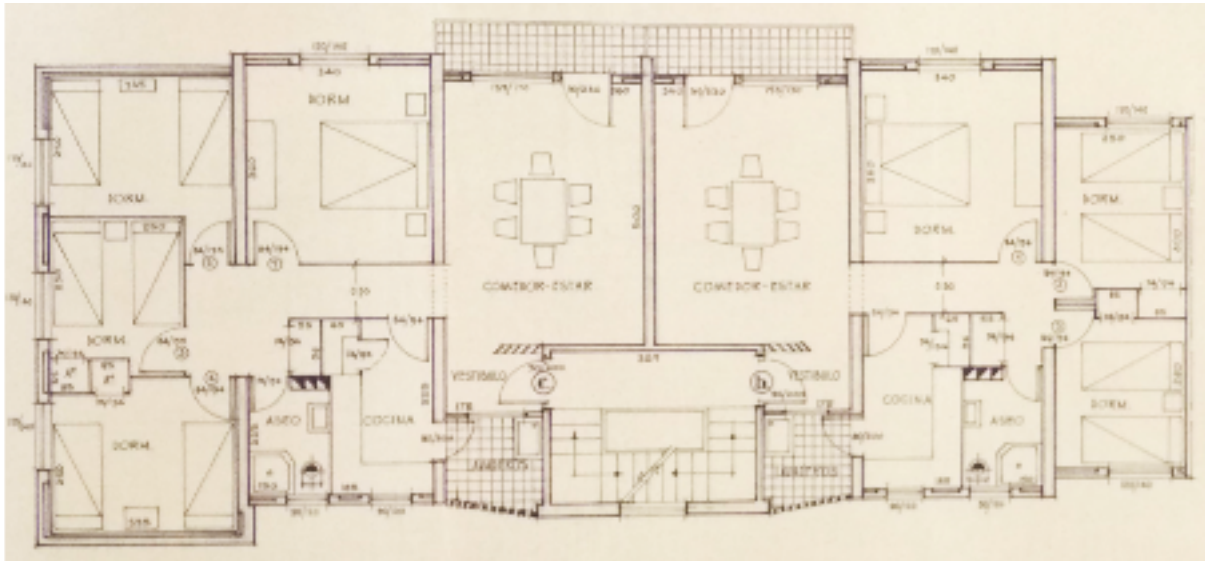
Planta del bloque H, escalera 5, PB (Fuente: Archivo Histórico Municipal de Castellón)
